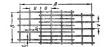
Сзариые сетки, в которых часть рабочих стержней не доводится ло края.
